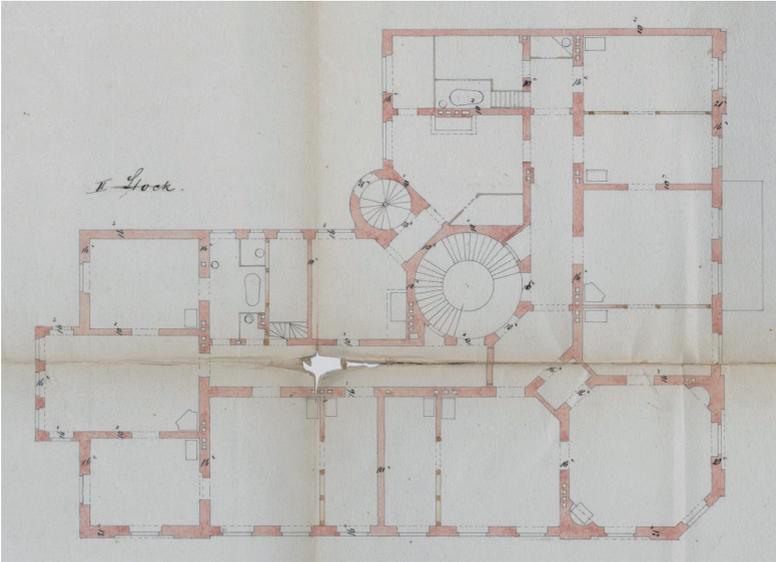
Grundriss In den Zelten 11, 2. Stock, vermutl. um 1900, da Badezimmer eingezeichnet sind (Landesarchiv Berlin, B. Rep. 202 Nr. 2163)
